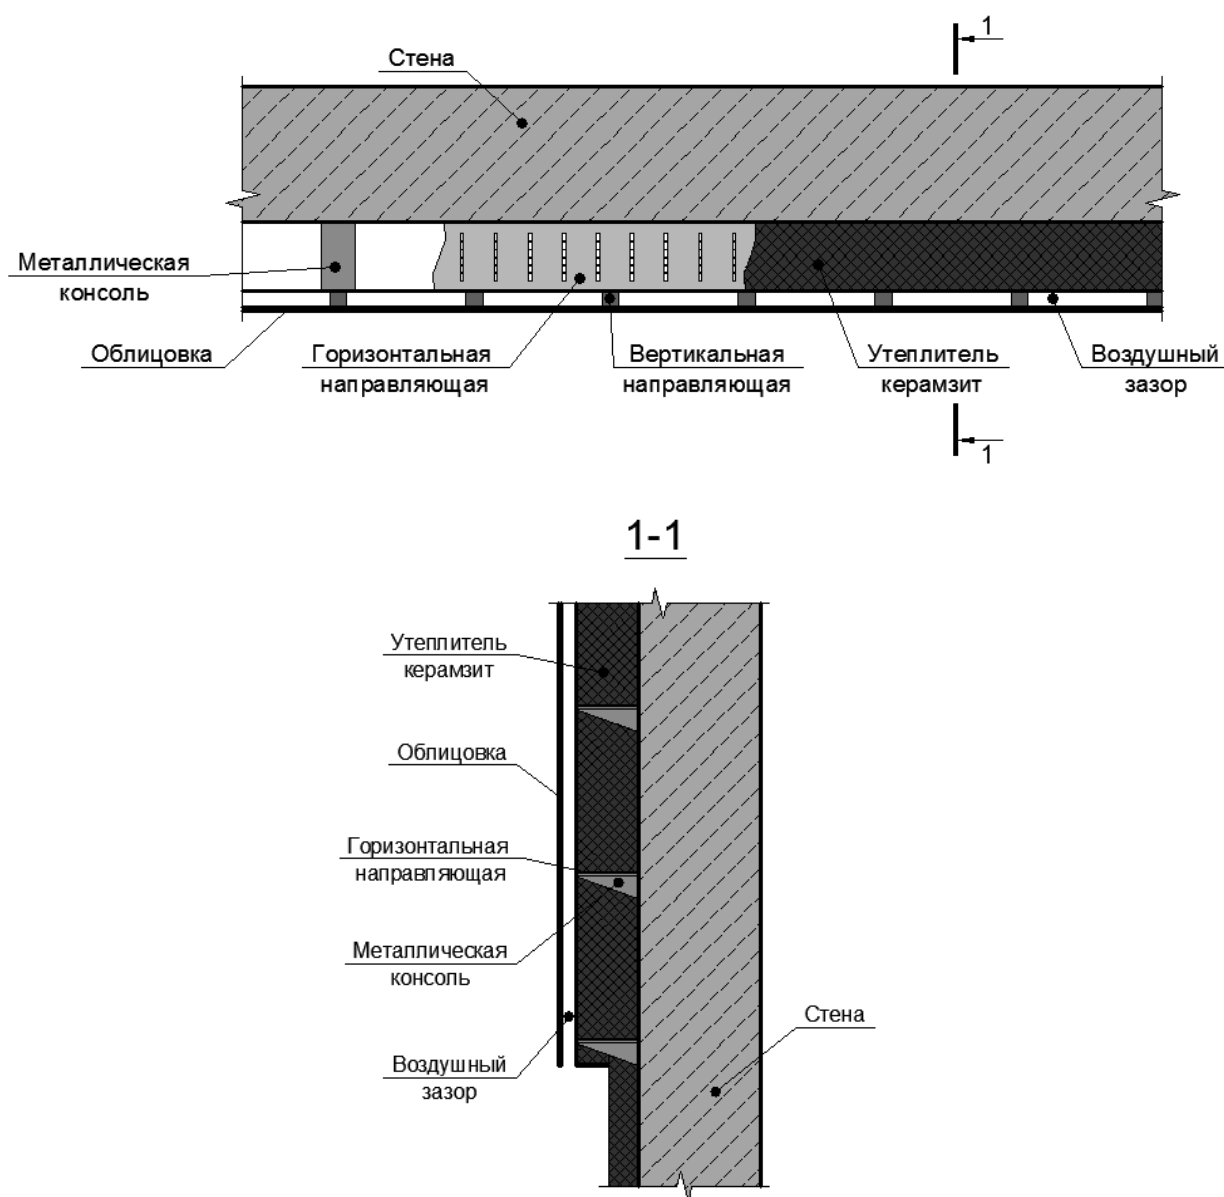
Предполагаемая конструкция вентилируемого фасада с утеплителем керамзитом
